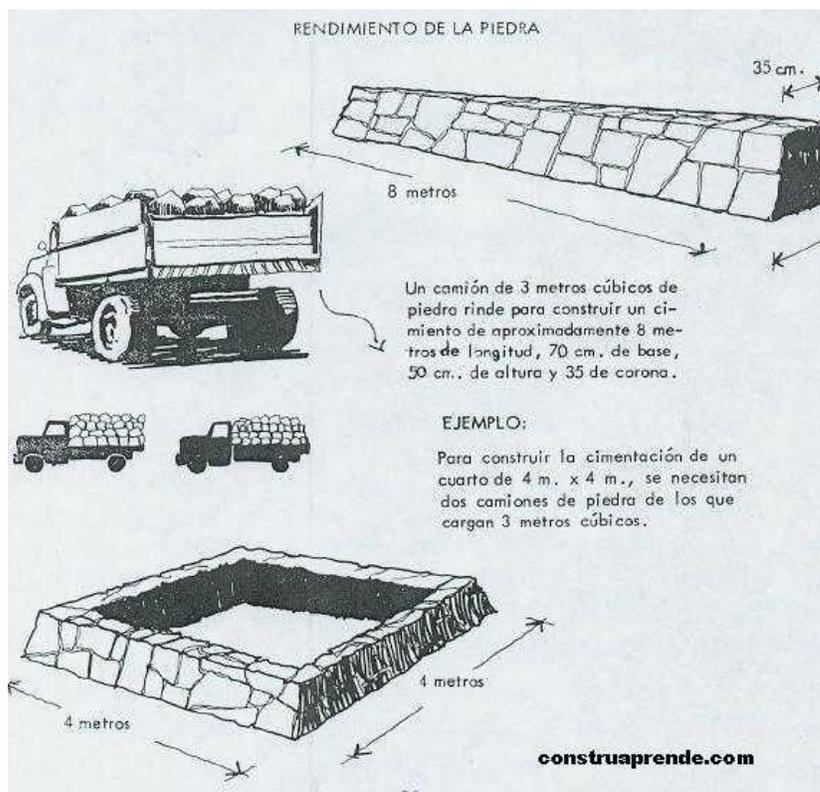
Rendimiento de la piedra para la construcción de muros.
